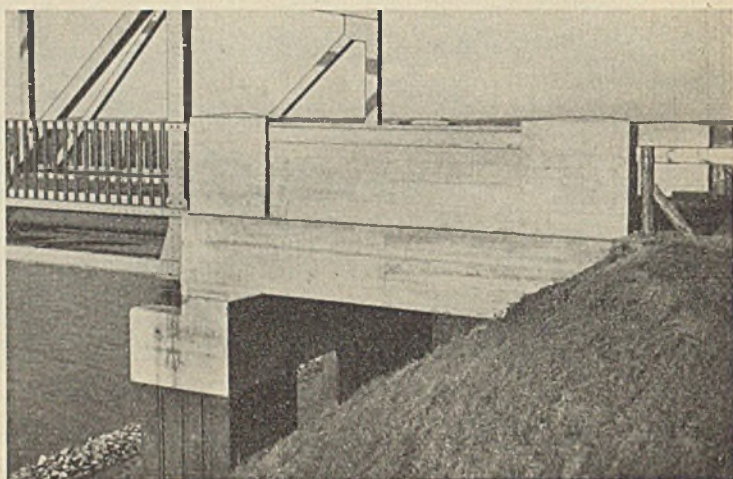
Feldwegbrücke bei Wenden. Blick gegen die Spundwandpfeiler.
